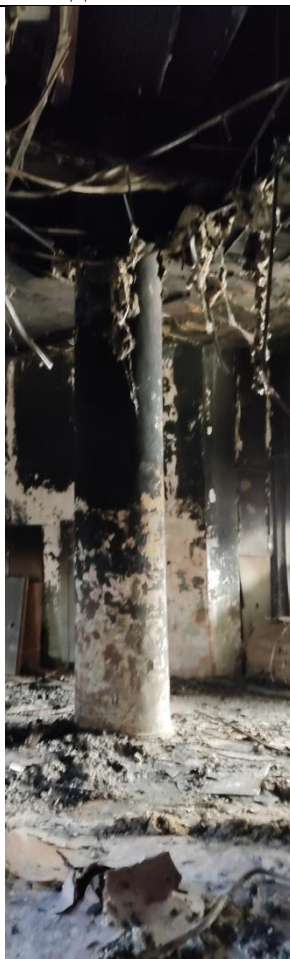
Разрушение защитного слоя бетона, оголение арматуры в колонне на 3 этаже здания в осях Б/7
